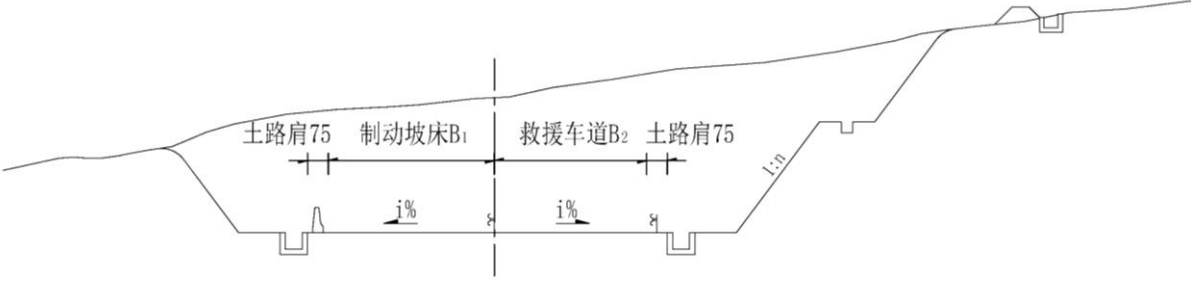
挖方避险车道标准横断面图（尺寸单位：cm）
